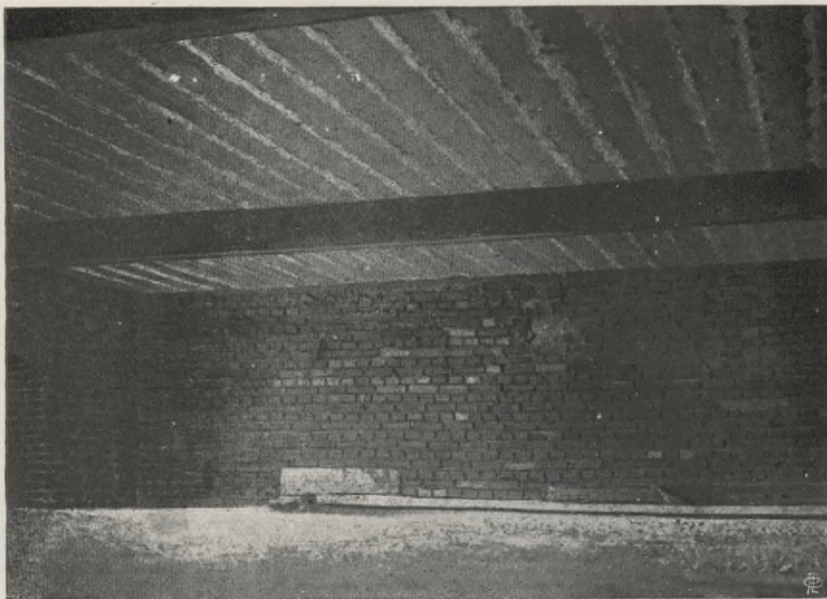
Unteransicht einer Siegwartbalkendecke auf Unterzügen von einbetonierten I-Trägern verlegt.
